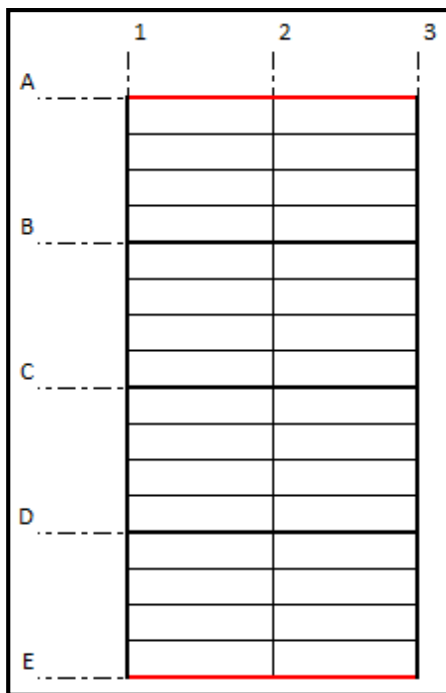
Vigas principales perimetrales en el eje “X”.
